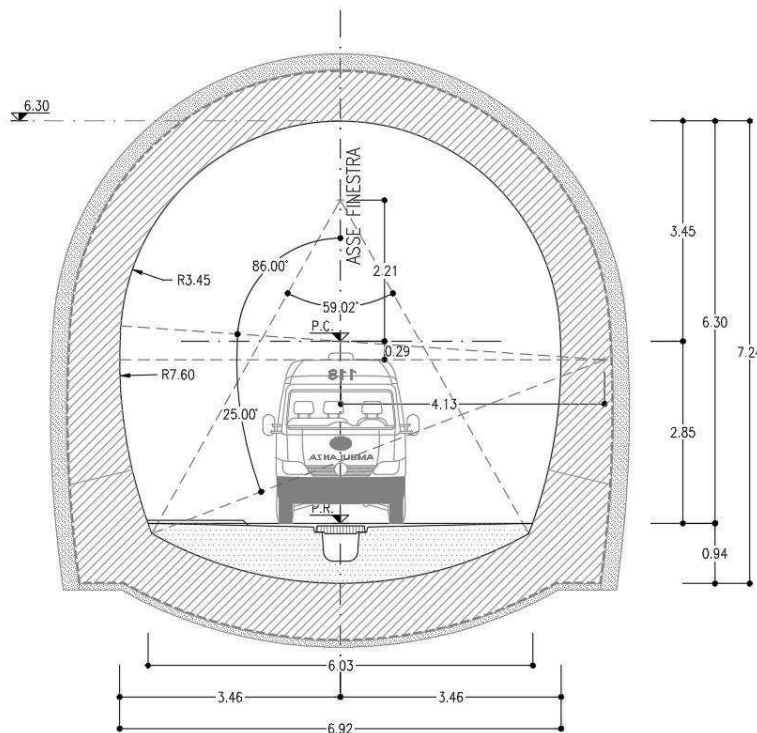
Sezione di intradosso di progetto della Finestra in configurazione definitiva (da [3.6])
